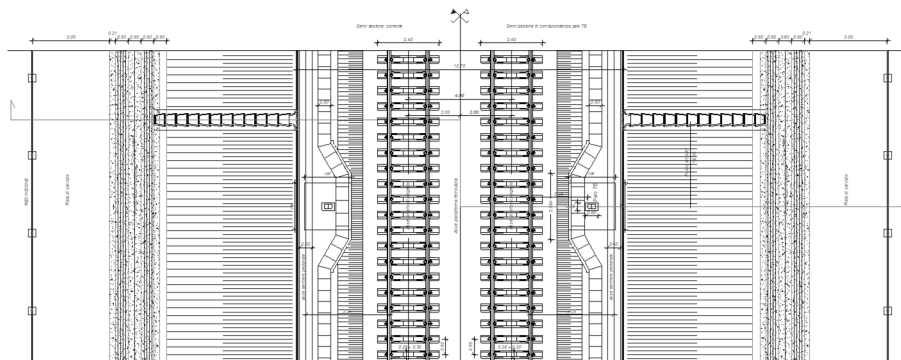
Stralcio planimetrico per sezione tipo ferroviaria in rilevato a doppio binario (piattaforma in retto) con  $H_{ril} \leq 6,00$  m
